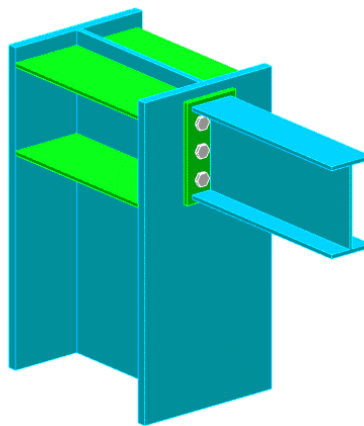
Vue 3D de l'assemblage poutre secondaire-poteau
